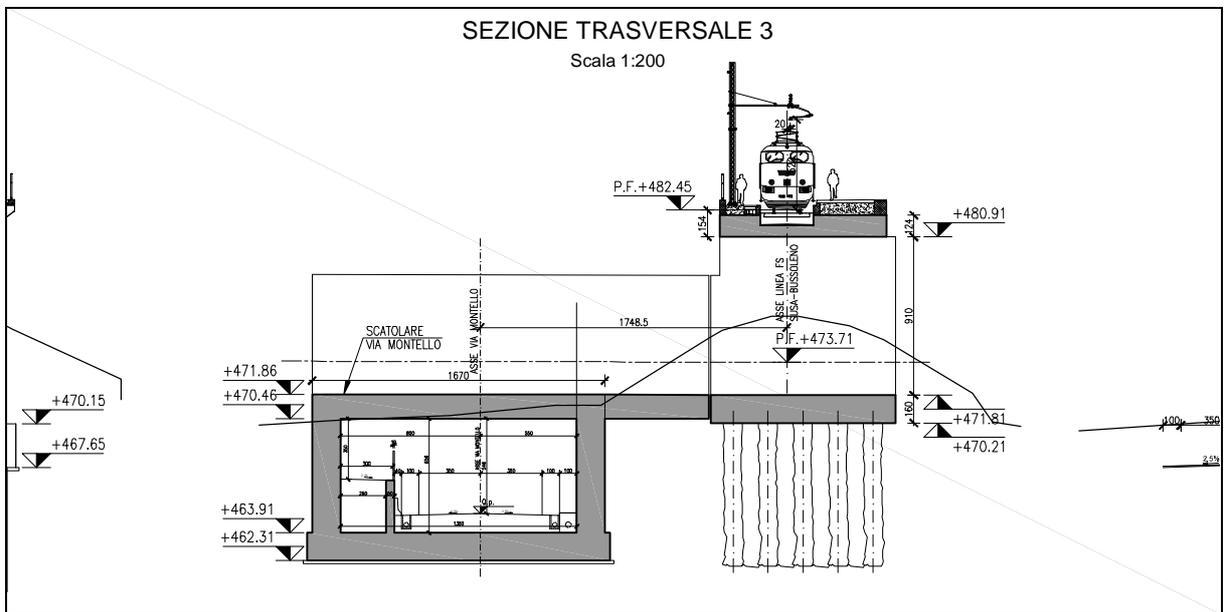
Sezione trasversale viadotto al di sopra della Stazione Internazionale
